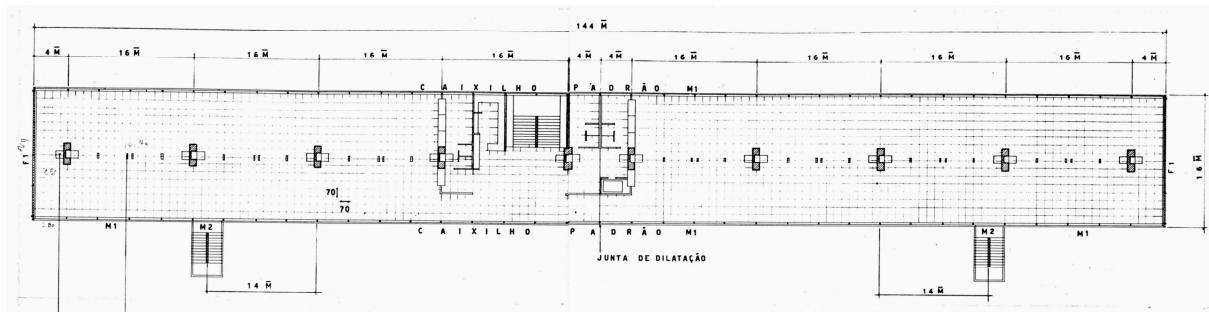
Planta pavimento tipo Bloco E1 (DUARTE e MANGE).
